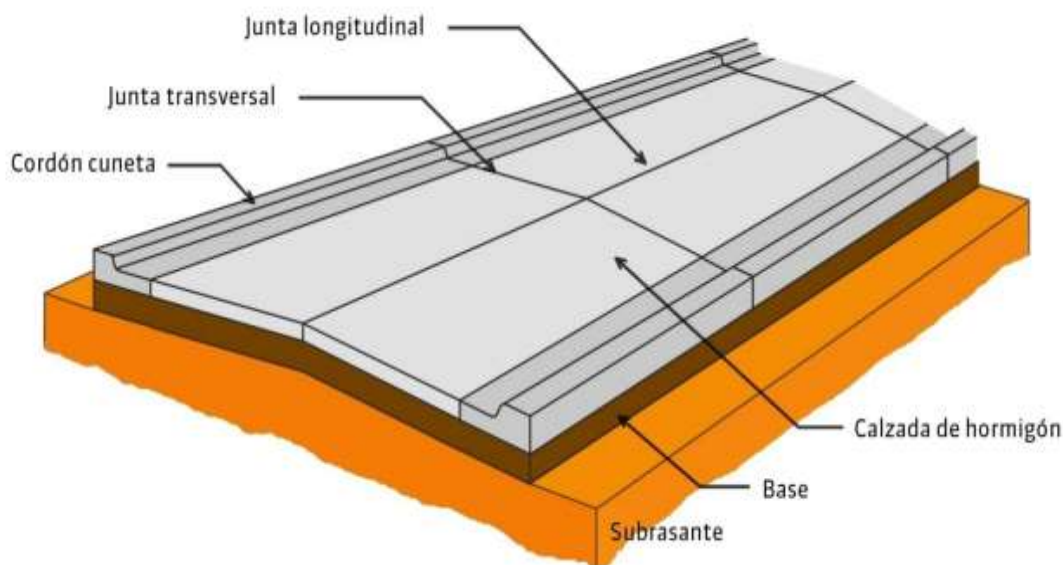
Sección típica de un pavimento rígido (Calo & Polzinetti, 2016).
